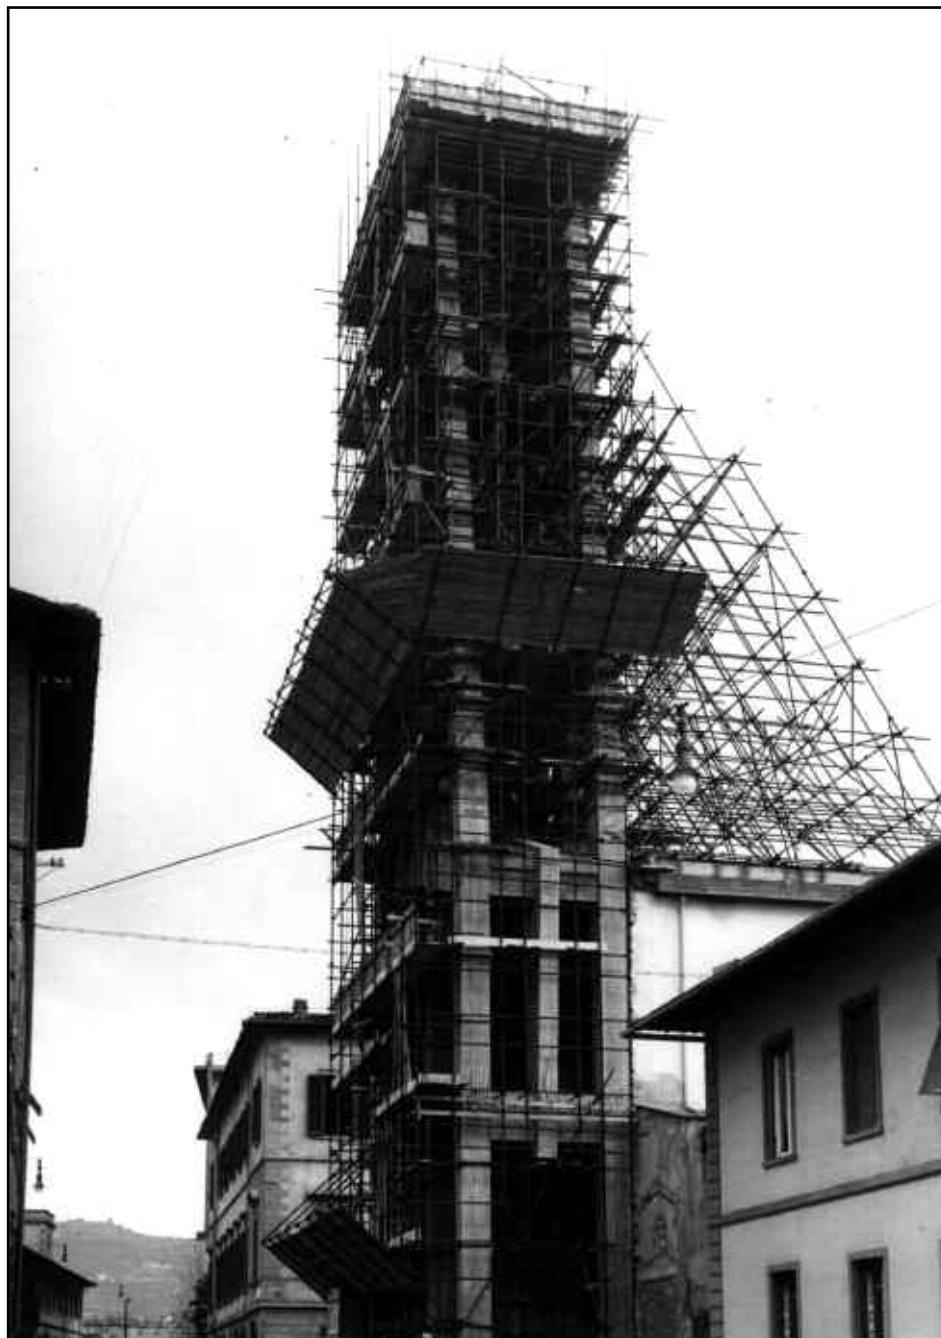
Foto del cantiere durante la realizzazione del campanile. È evidente il giunto tra le due strutture.
